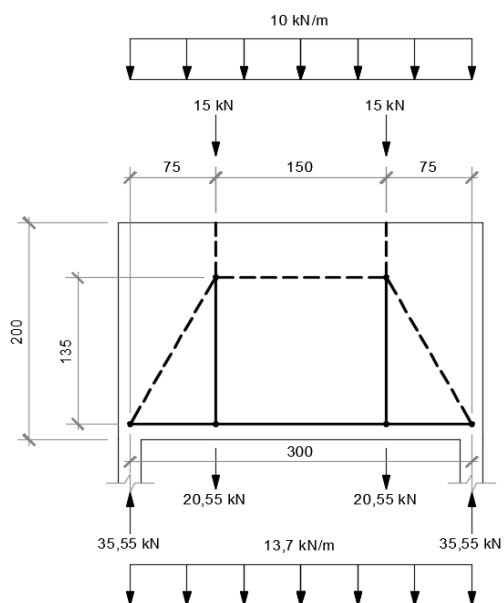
Modelo de bielas e tirantes para a viga parede da caixa d'água
